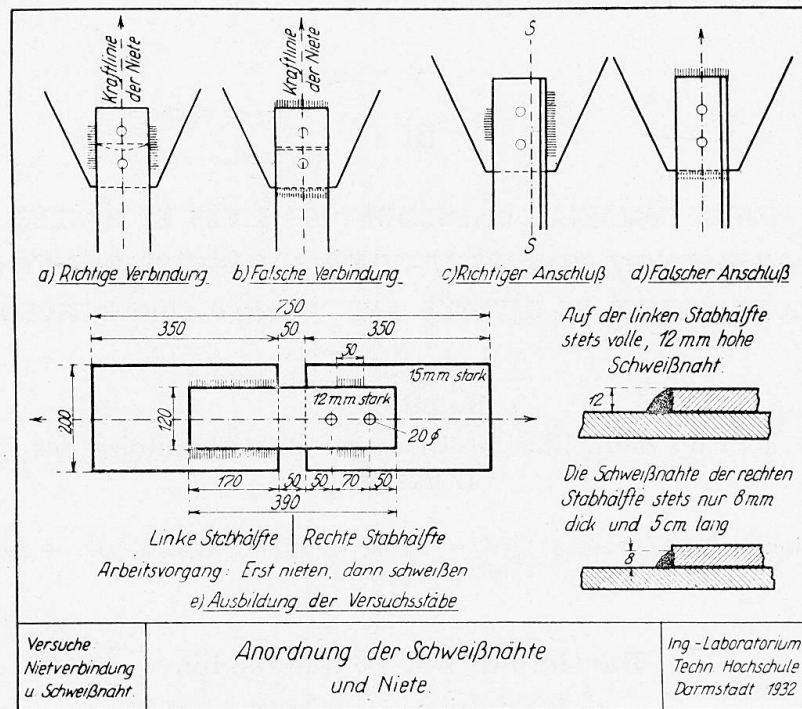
Disposition des cordons de soudure et des rivets
